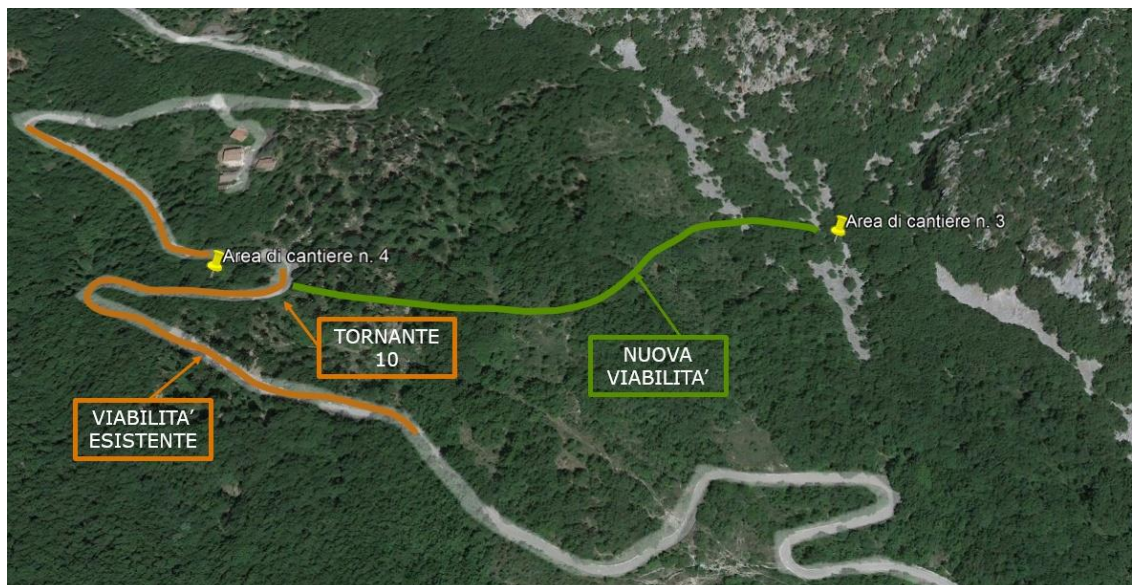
Viabilità di accesso alle aree di cantiere n. 3 e n. 4
